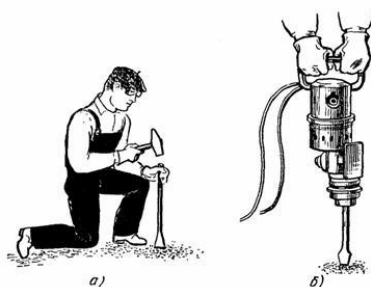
Срубание выступов, насечка бетонных поверхностей: а - скарпелем или зубилом, б - электрическим молотком
